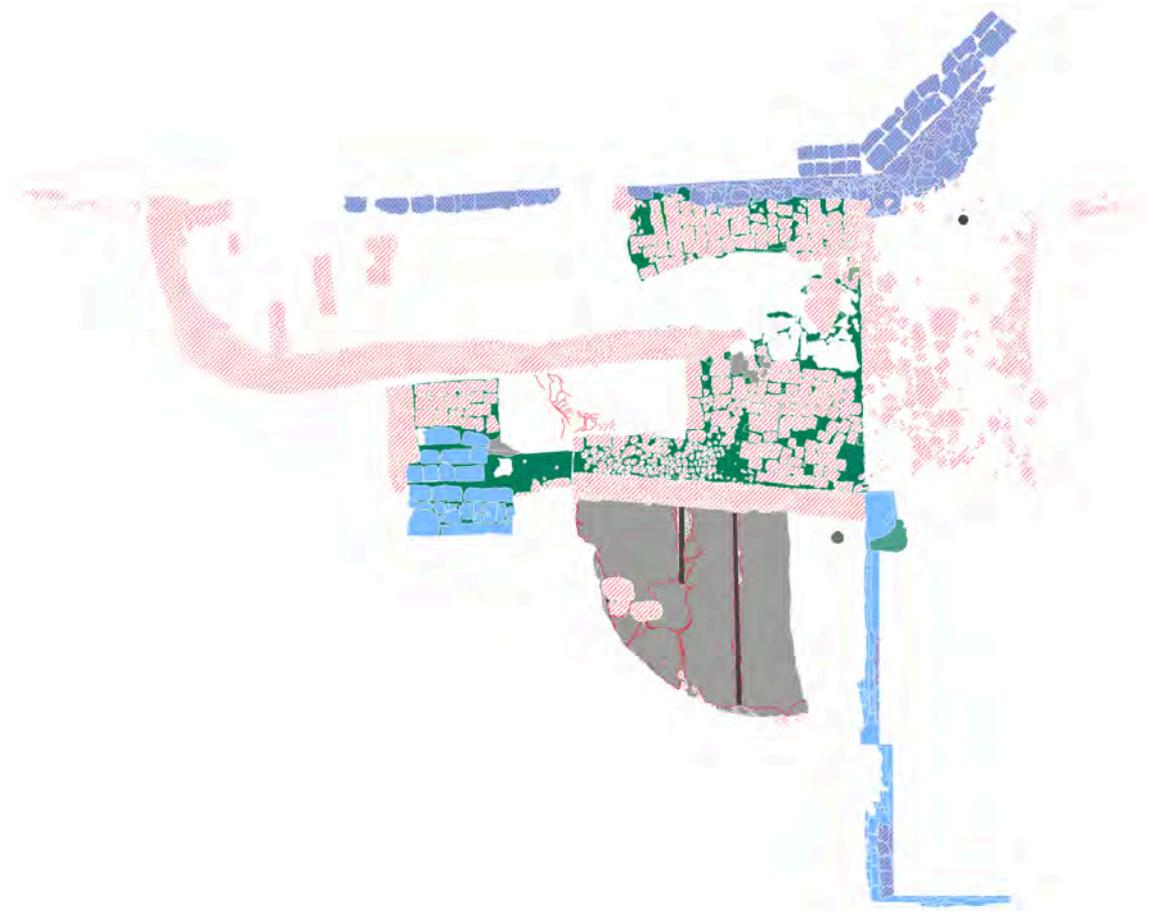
Ausschnitt aus Anlage III.5.1 Grundriss Kartierung Zustände und Schäden
